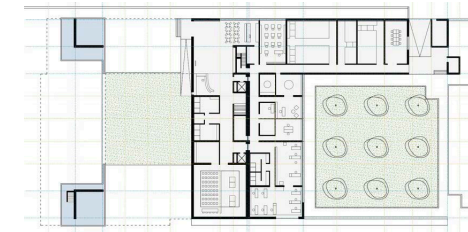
Planta baixa da Biblioteca Municipal de Viana do Castelo.
